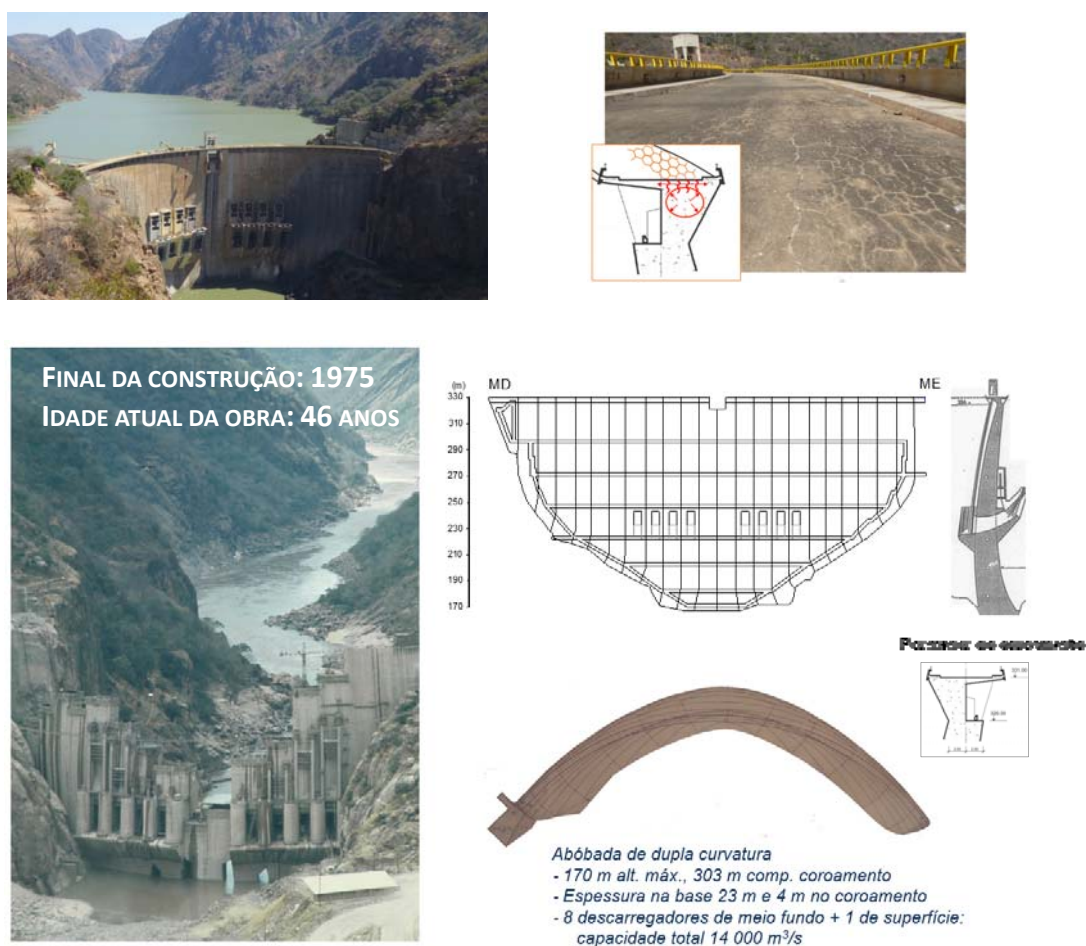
Barragem de Cahora Bassa. a) Vista da barragem; b) Fissuração no coroamento; c) Fase de construção. d) Geometria da obra: alçado, consola central e planta.
